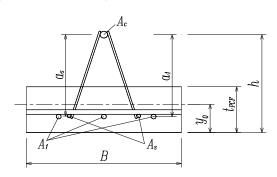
单根钢筋桁架形成的组合梁单元断面图示
